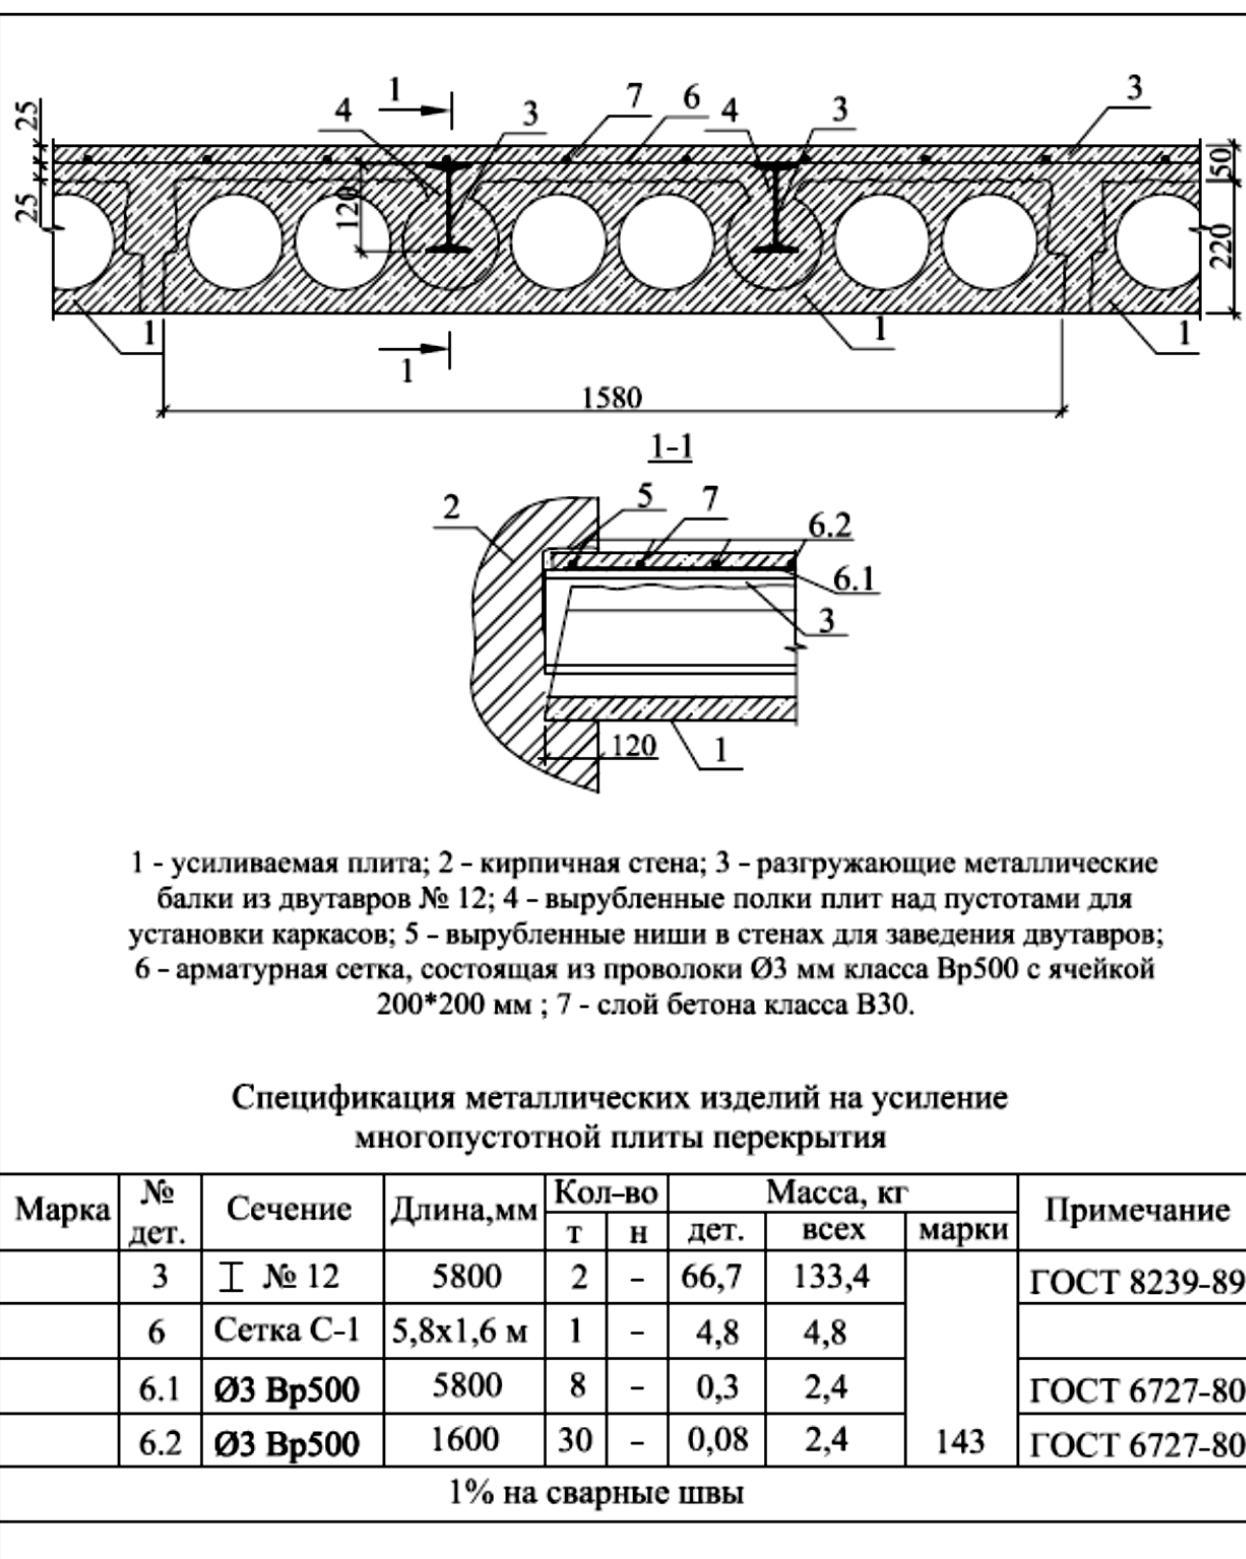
Усиление многопустотной плиты перекрытия подведением разгружающих балок
